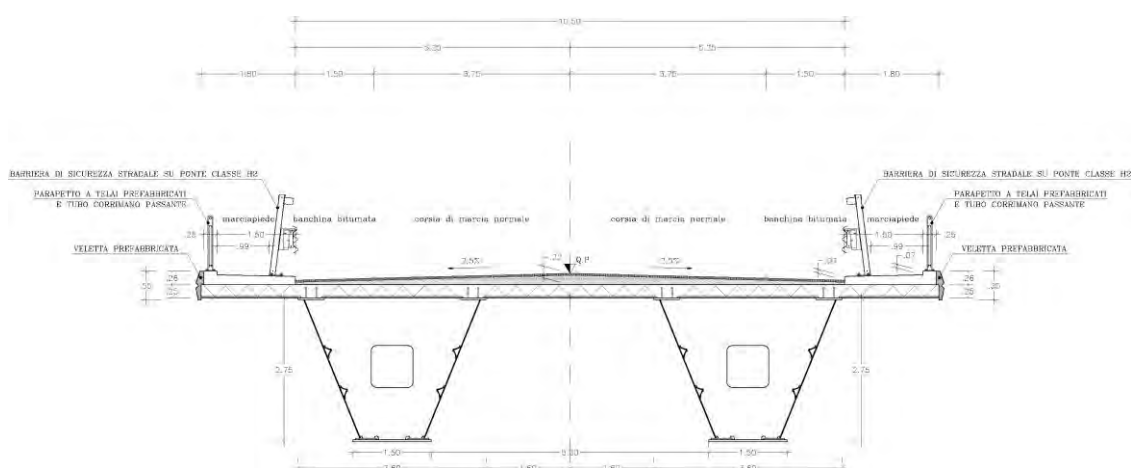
Sezione tipo ponte sul fiume Bacchiglione
